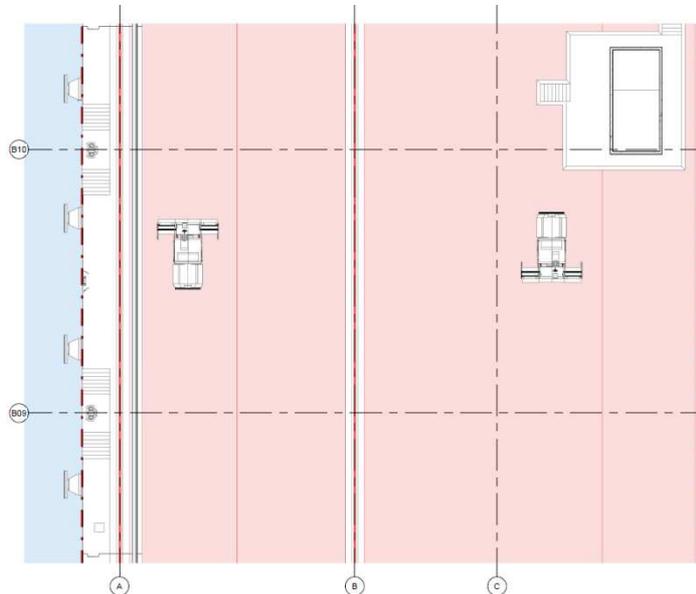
Planimetria con indicazione della pavimentazione stradale.
